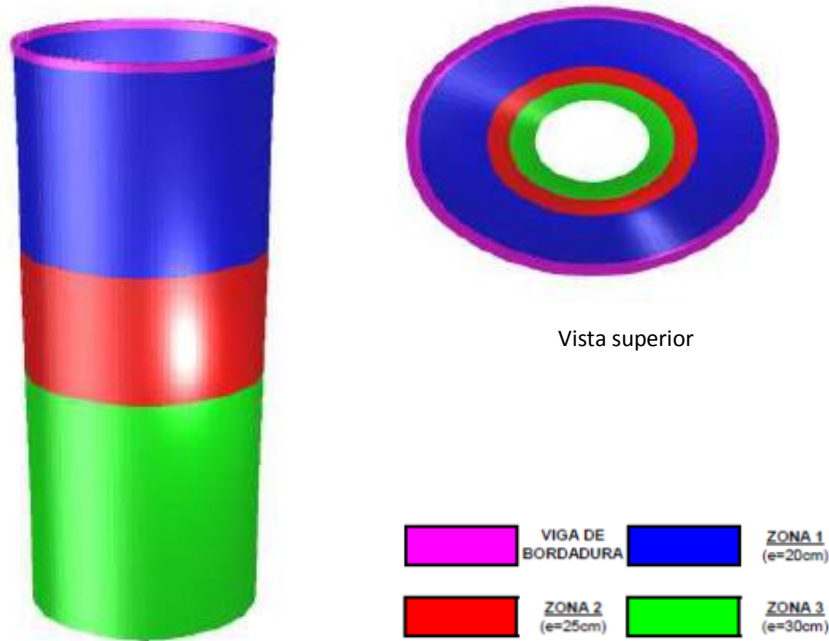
Ilustração das diferentes espessuras do revestimento primário do PV (adaptado CJC, 2009).
